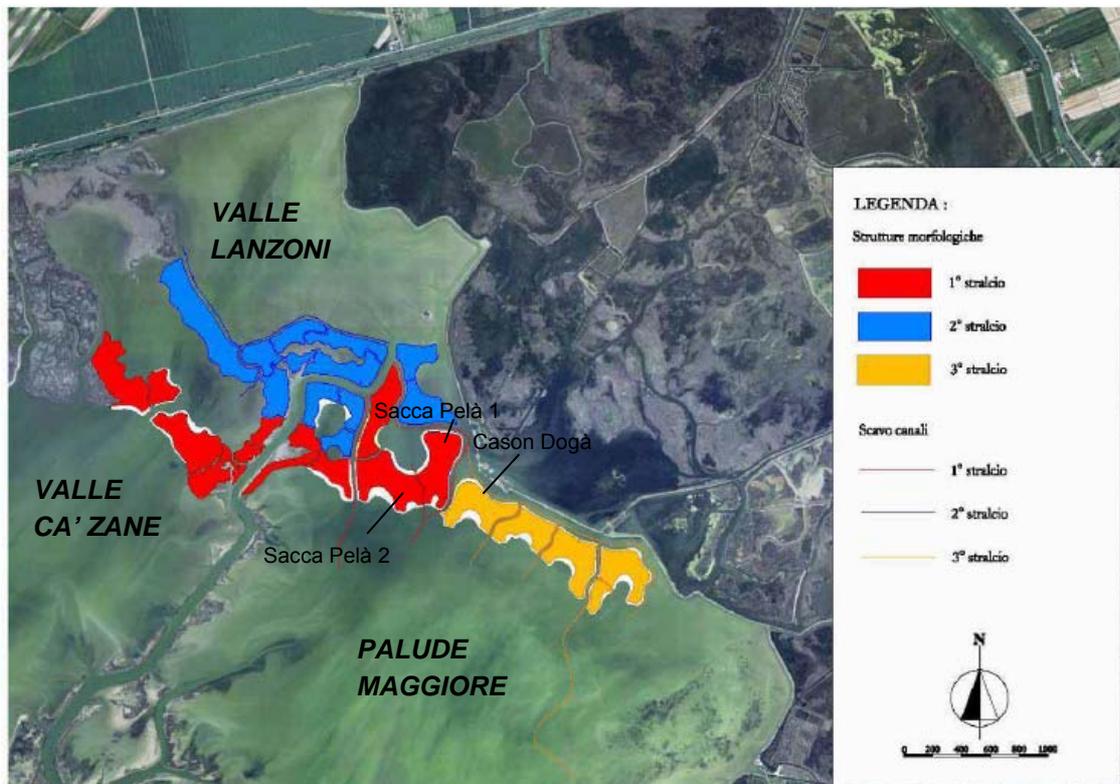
Planimetria progetto definitivo dell'area del canale Cenesa con le tre fasi esecutive.
